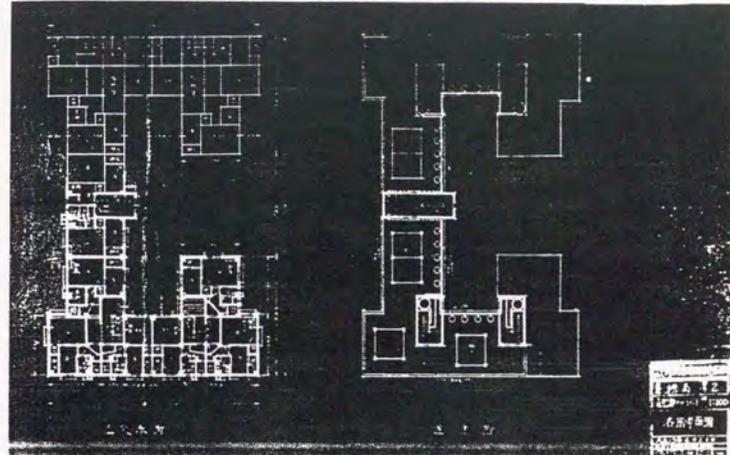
柳島第2号アパートメント各階平面図、1/100、大正15年
